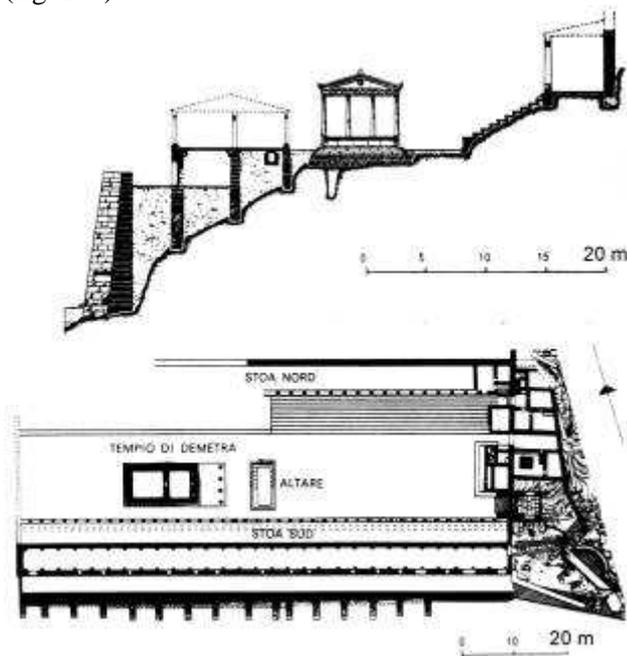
Pergamo. Santuario di Demetra (fine III, inizio II sec. a.C.). Pianta e sezione trasversale (BERVE – GRUBEN 1961)
